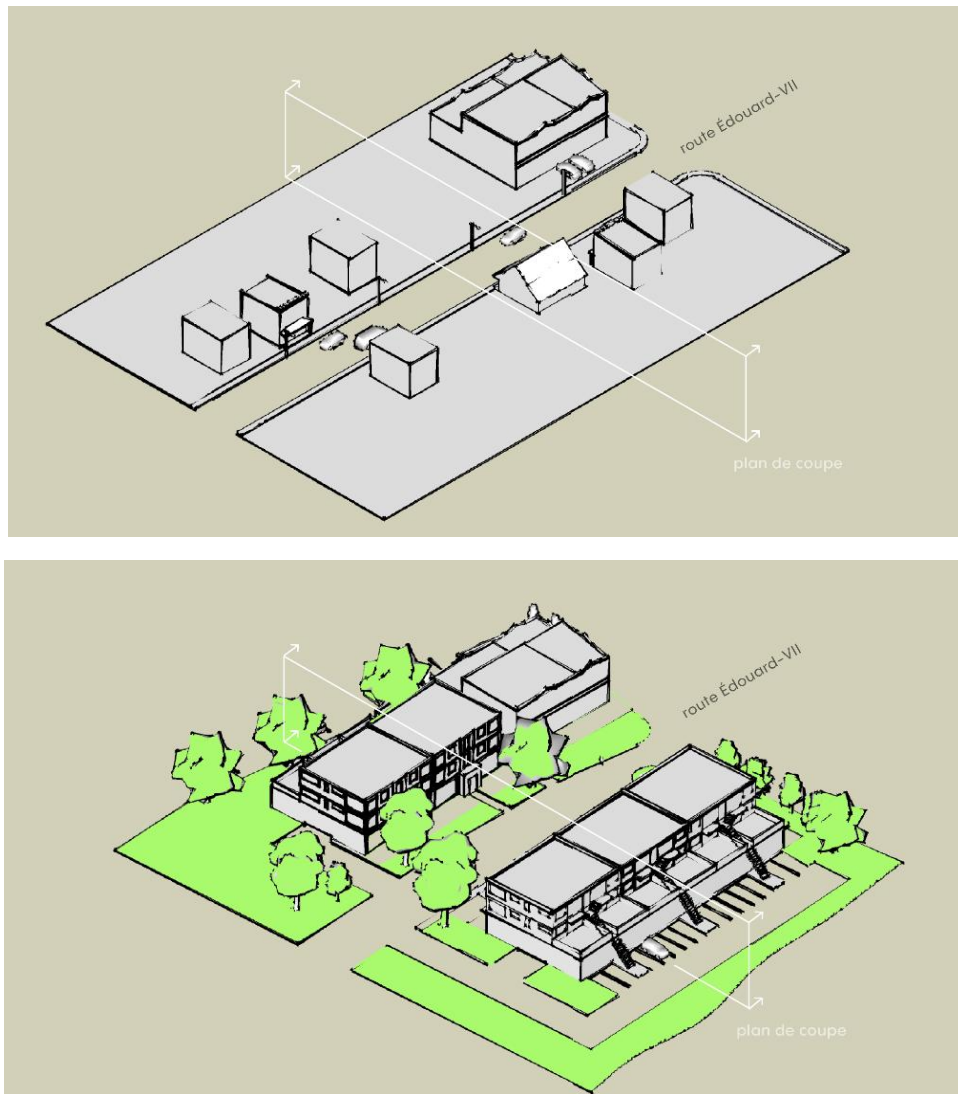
Vue en axonométrie illustrant les conditions existantes et souhaitées (route Edouard VII) avec division parcellaire régulière, cours avant et stationnement sur rue, et architecture inspirée des formes traditionnelles du noyau villageois
